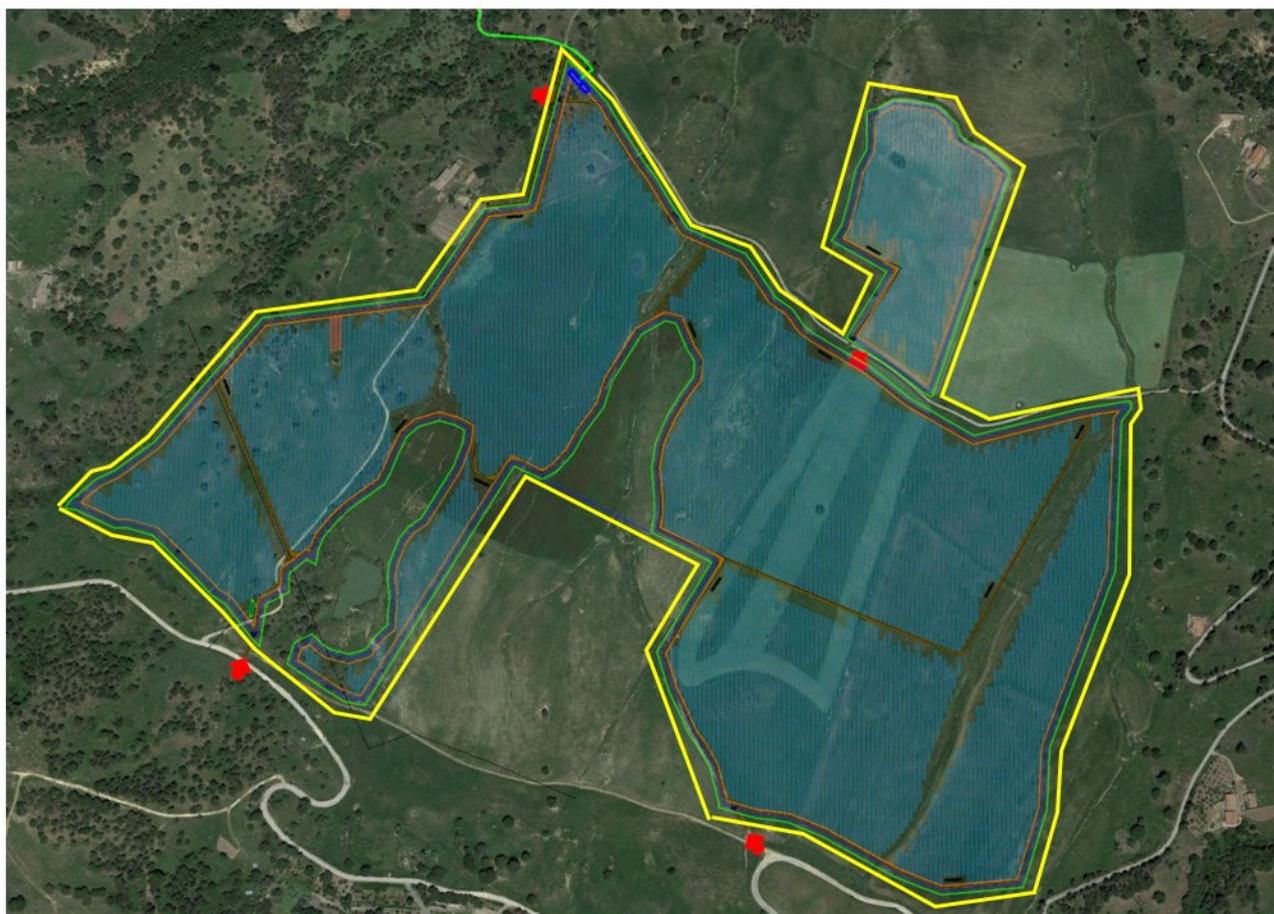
opera di mitigazione sul perimetro dell'impianto.
